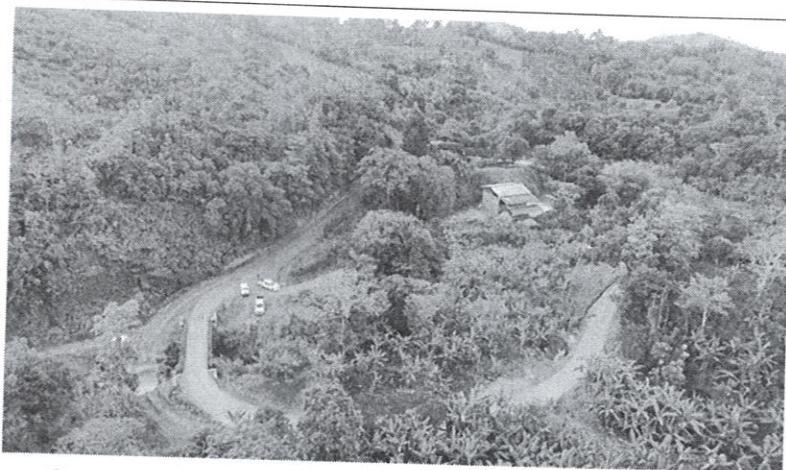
Fotografía aérea del área donde se llevará a cabo el proyecto. En la imagen se puede observar el sitio donde actualmente se encuentra el puente tipo bailey, así como la vegetación existente en los alrededores de la zona del proyecto.
